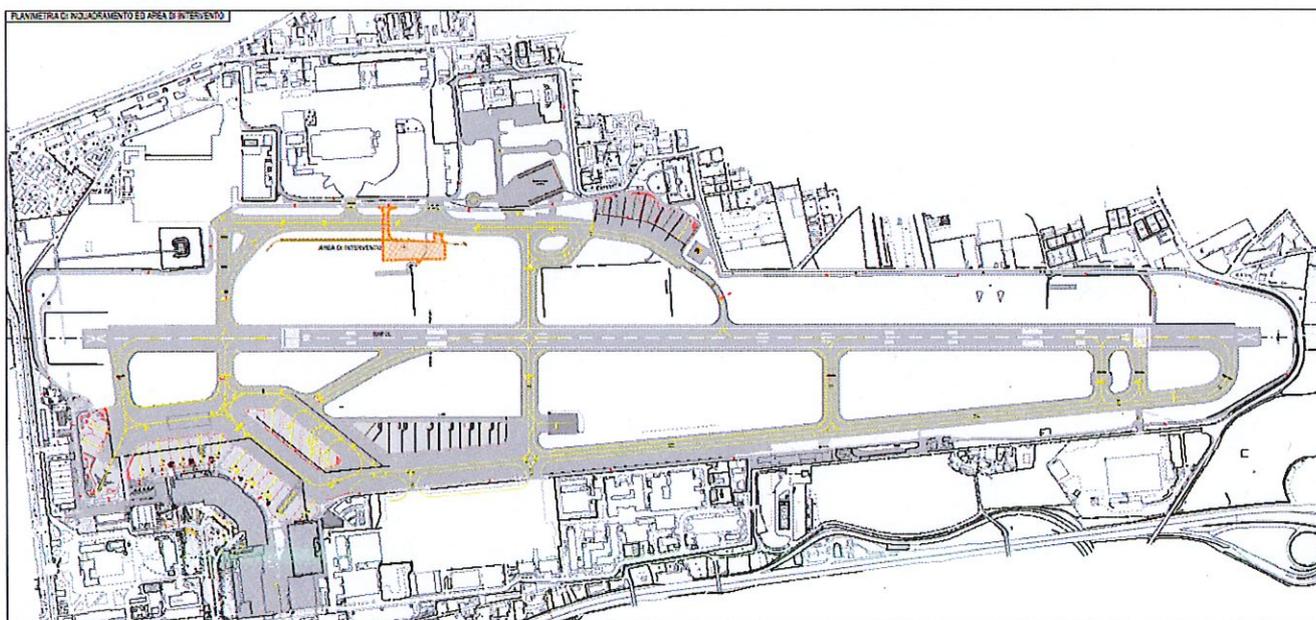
Stralcio elaborato C244403-GEN010 Planimetria di inquadramento
